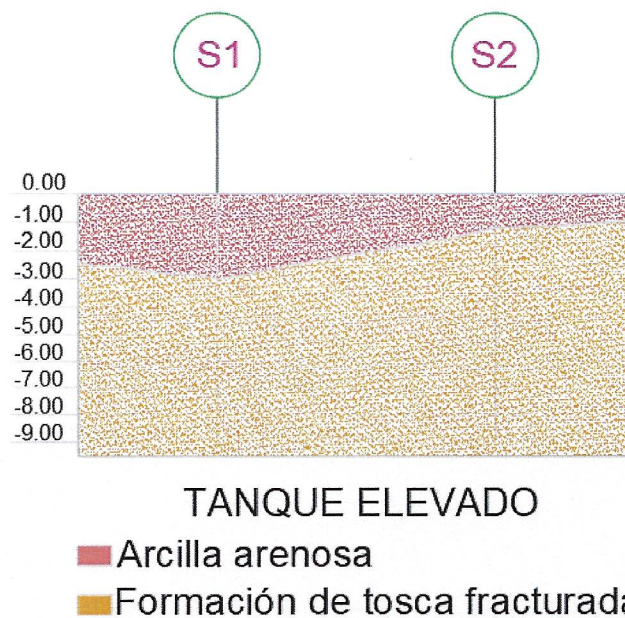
Perfil estratigráfico – sección Para tanque elevado.
